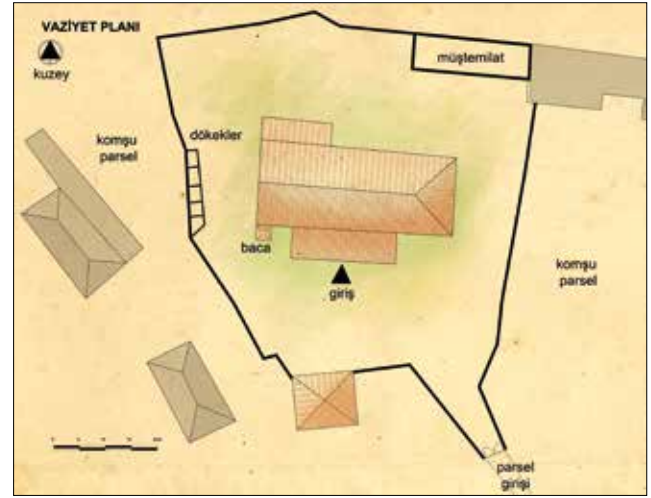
Nusratlı Köyü'nde bulunan zeytinyağı fabrikası vaziyet planı şeması (Ayvacık) / The site plan of the olive oil factory in Nusratlı village
